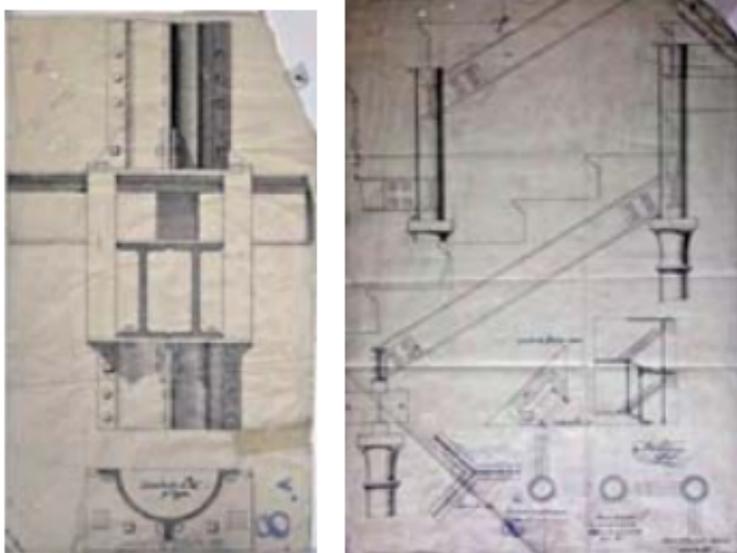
Proyecto para reformar el Mercado Principal; fachada, corte y detalles constructivos, arq. Antonio Torres Torija, 1873. En: AHDF, Planoteca; Planero 1; Módulo 3; Fajilla 41. Foto: RV, 2012
